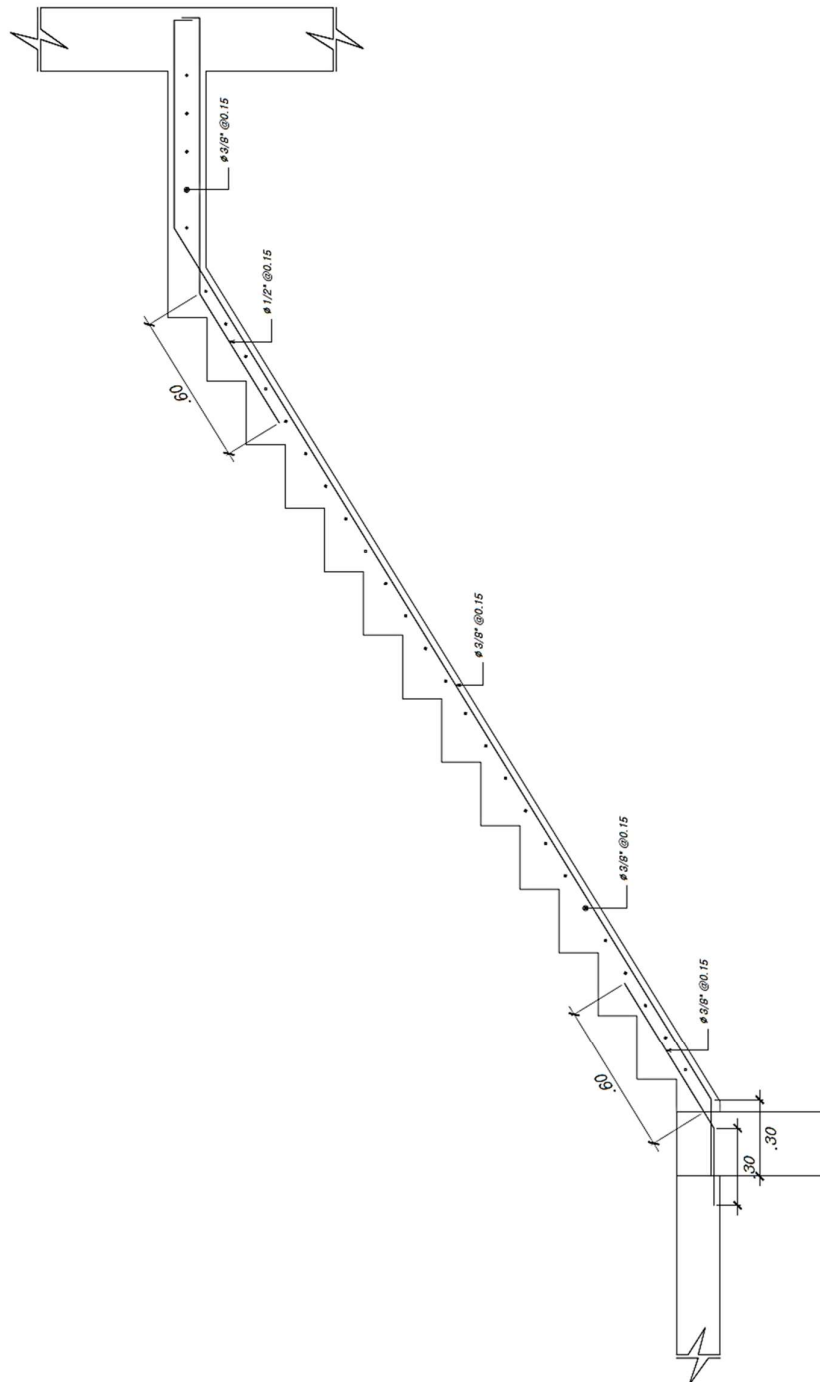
Armado de refuerzo de escalera. Fuente propia.
